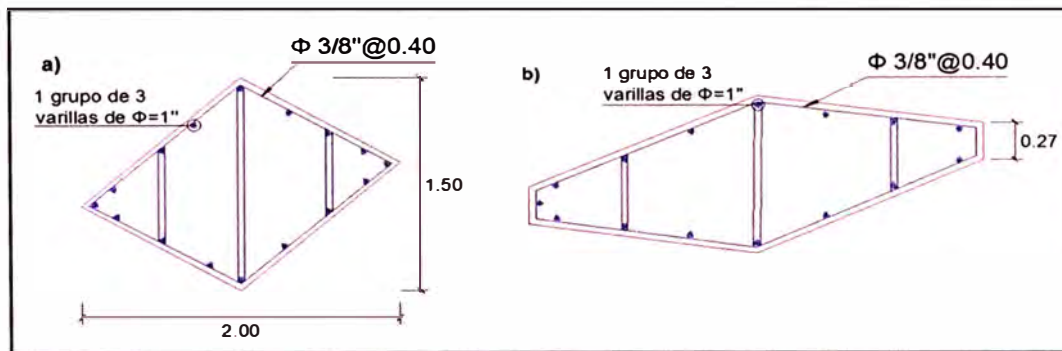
a) Corte G- G, base inferior y b) Corte F- F, a media altura de la columna.
